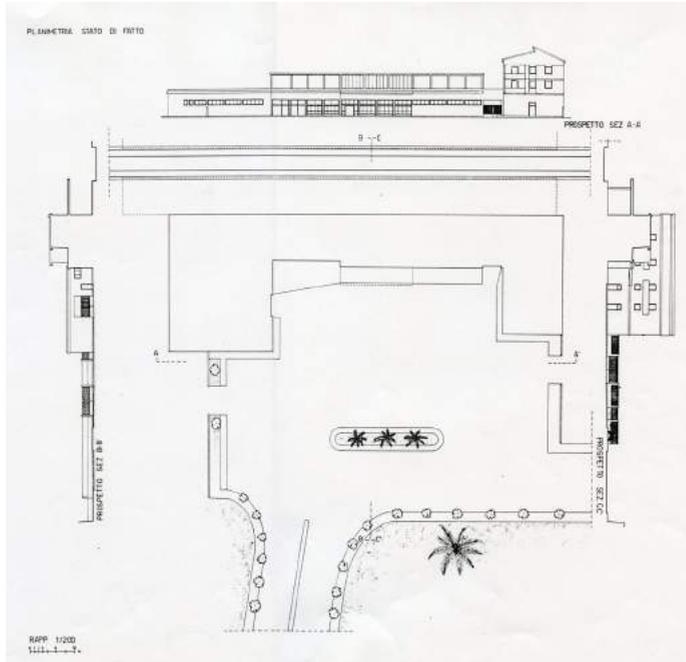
N.G. Leone, *Progetto di trasferimento della fontana Scelba nella piazza della ferrovia, (1989)*. Planimetria e prospetto di stato di fatto della piazza della ferrovia; eseguito in c.a.d., stampa in b.n. su carta, rapp. 1:200.
